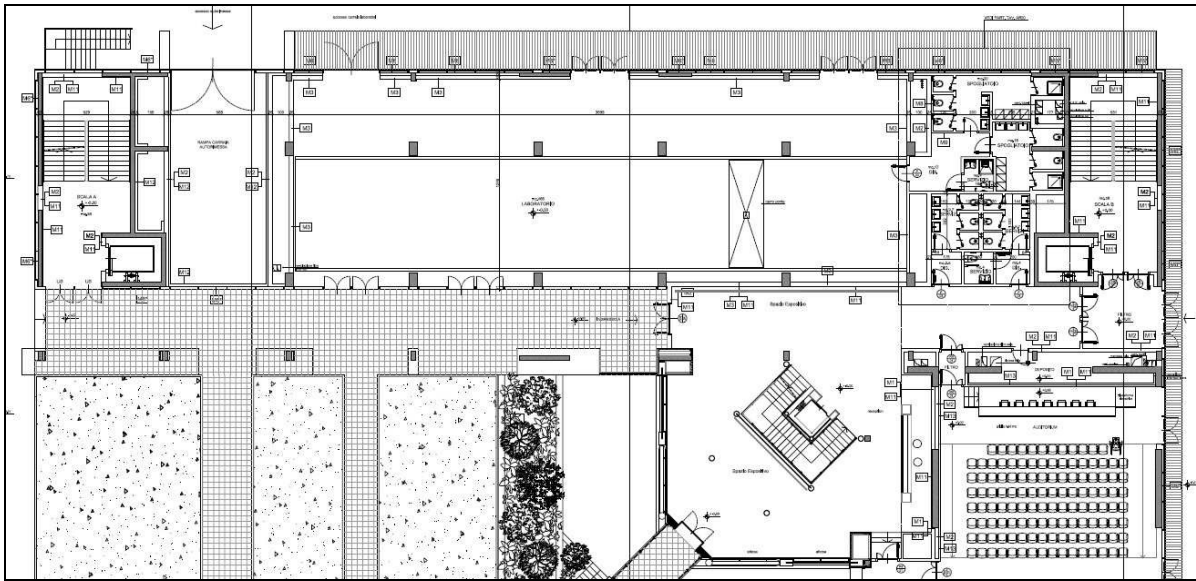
Stralcio della pianta del piano terra con indicazione della collocazione dell'ambiente ricevente (laboratorio).
